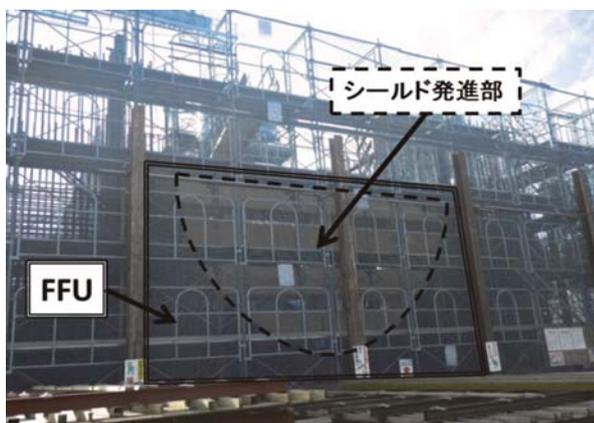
FFUを組み込んだ立坑の様子(半断面施工中)
